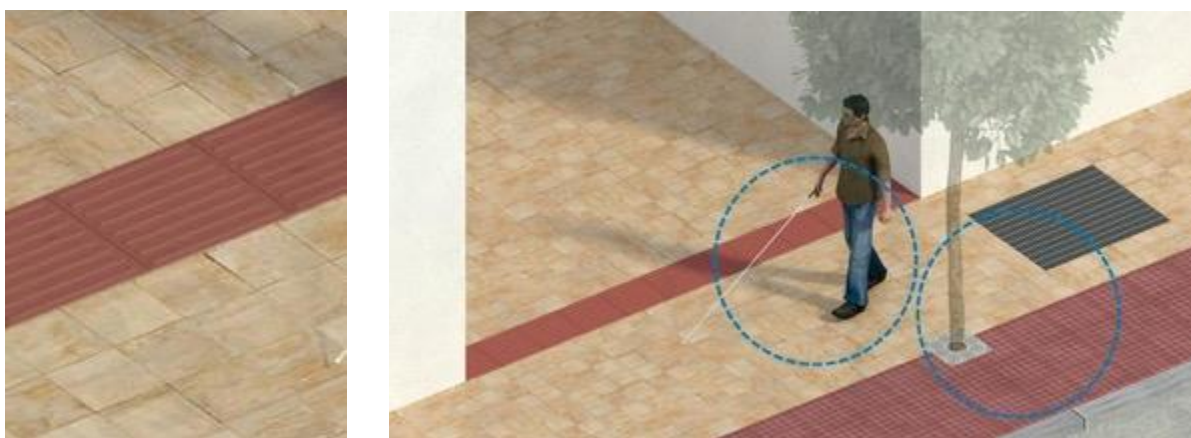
Banda de pavimento táctil indicador en ausencia de línea de fachada por retranqueo de la misma
